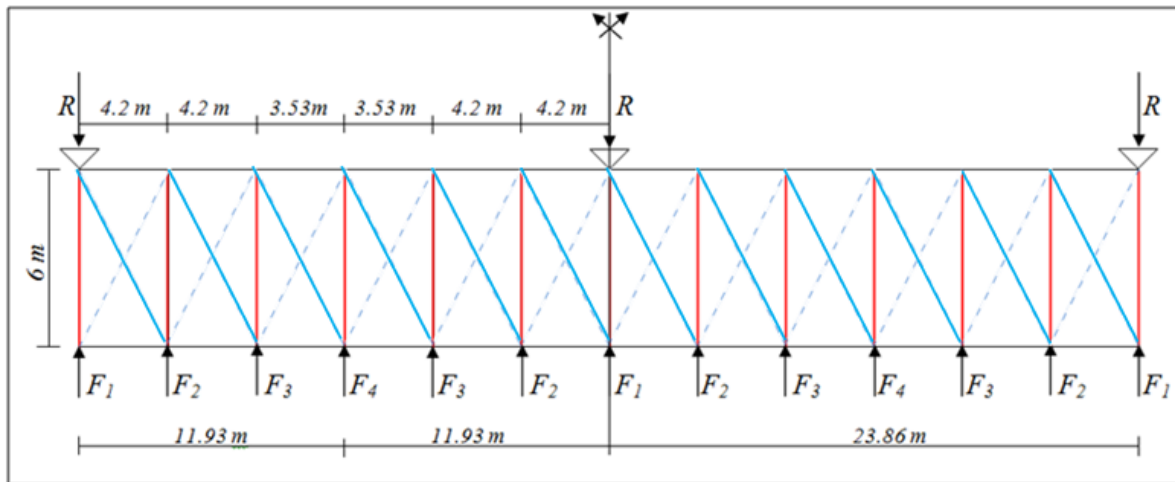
Schéma statique de la poutre au vent (effet de traction).
